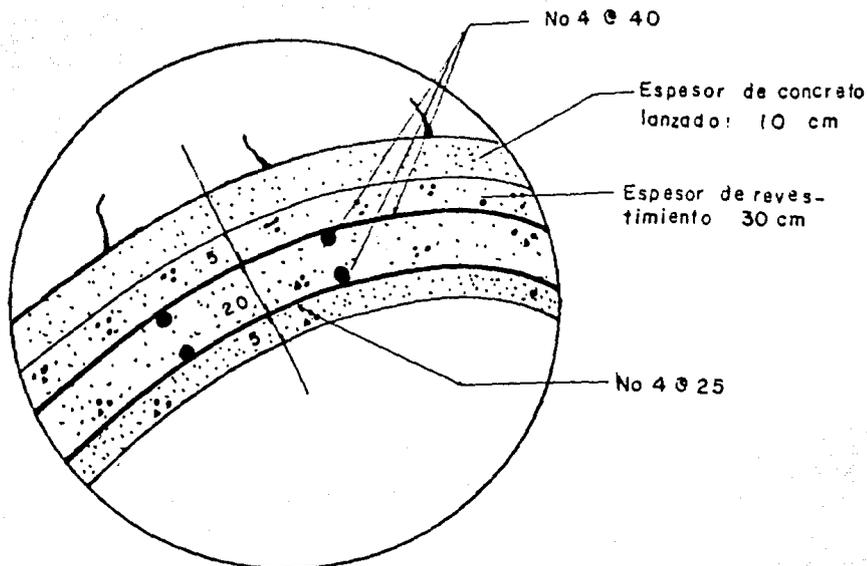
ARMADO DE REVESTIMIENTO DEFINITIVO Y ARMADO DE BANQUETAS
